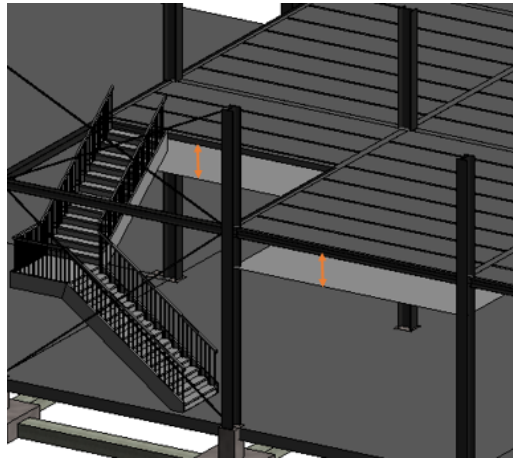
Desfase entre techo y forjado de la primera planta.
